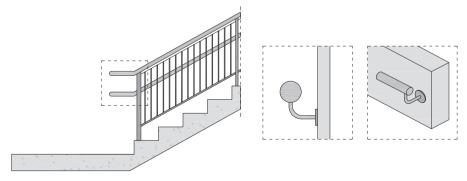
Sección longitudinal de escalera y detalle de pasamanos.
